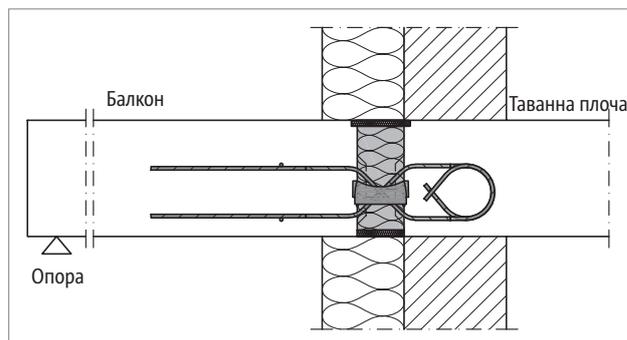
Schöck Isokorb® T mun QL, QL-VV: Балкон с двустранен контакт и опора
